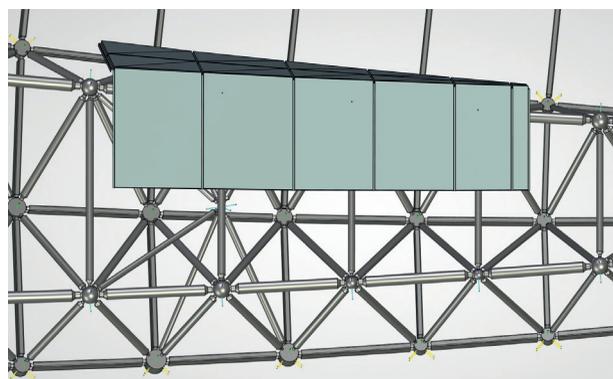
Кассеты заворачиваются по поверхности двойной кривизны (вид снизу)
